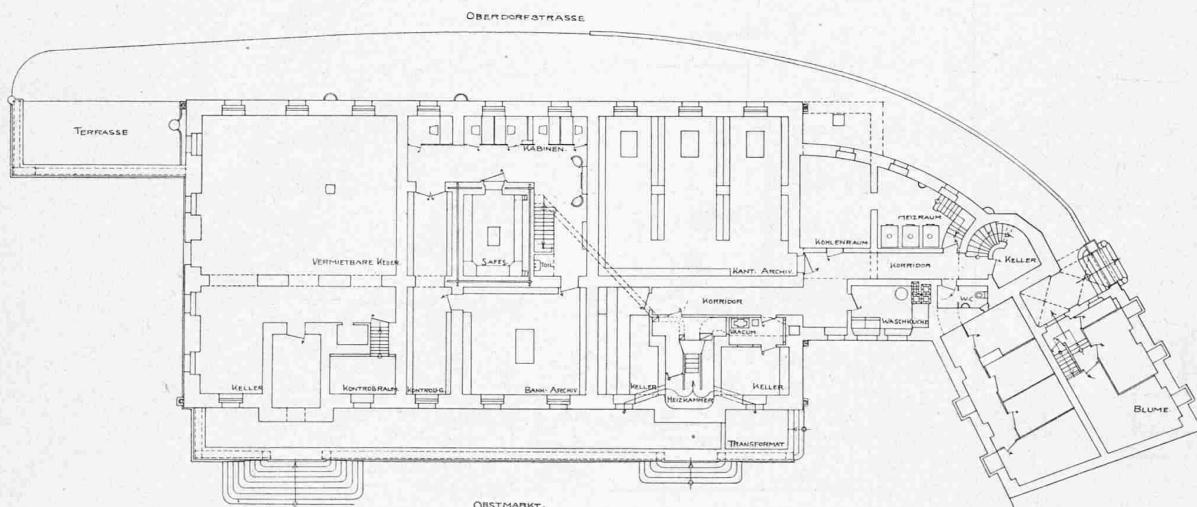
Grundriss vom Untergeschoss — Maßstab 1:400
